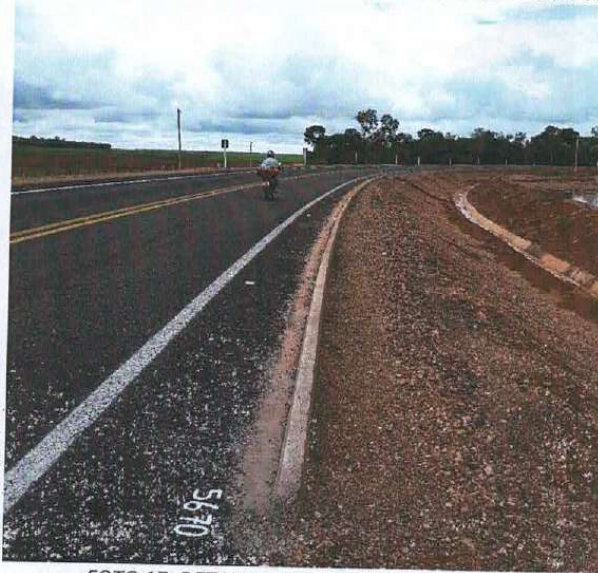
DETALHE DO MEIO-FIO EXECUTADO
